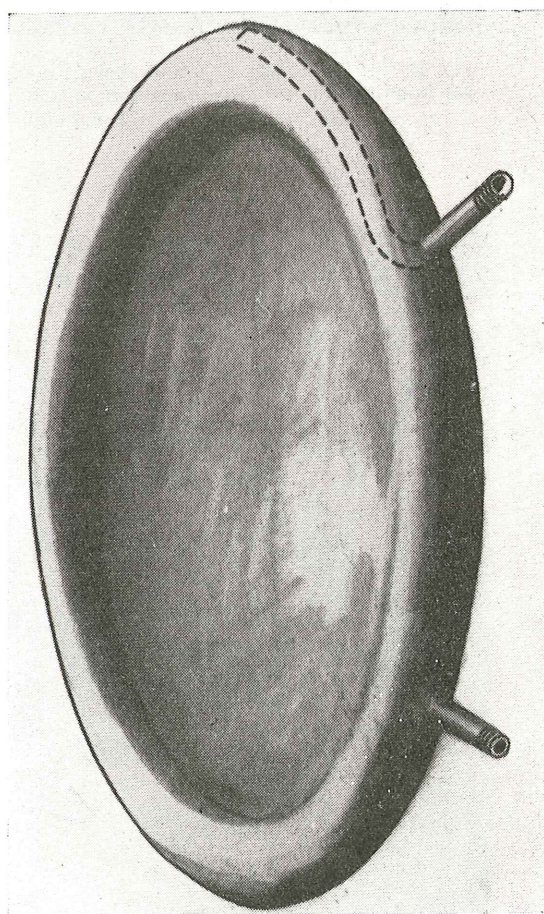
Gato plano del tipo utilizado en las paredes verticales. (Obsérvese la entrada para la inyección situada abajo y el tubo de salida del aire en la parte de arriba.)
